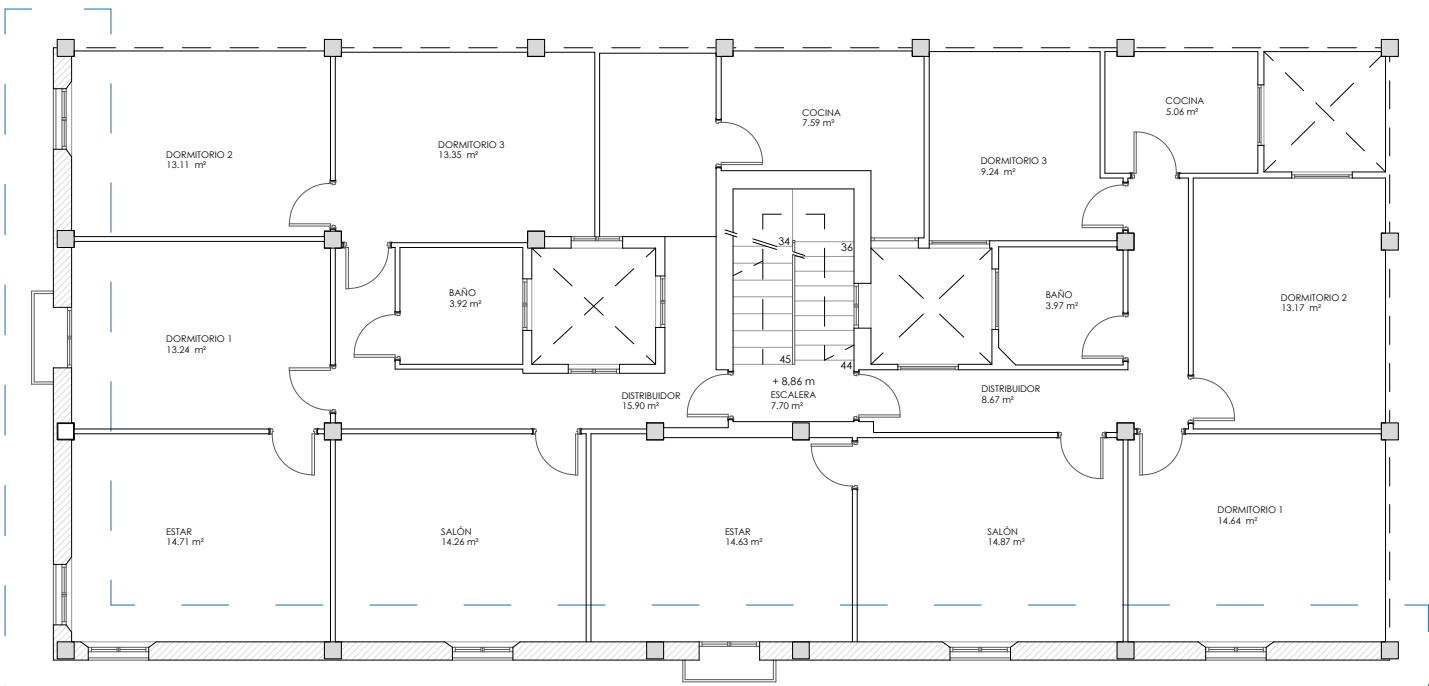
Planta del sistema vivienda tipo 1 y tipo 2 para la ciudad de Valdivia. Se adjuntan especificaciones en Anexo (Detalle tipo solución 2, varía el espesor de aislamiento). Fuente: Creación propia.
